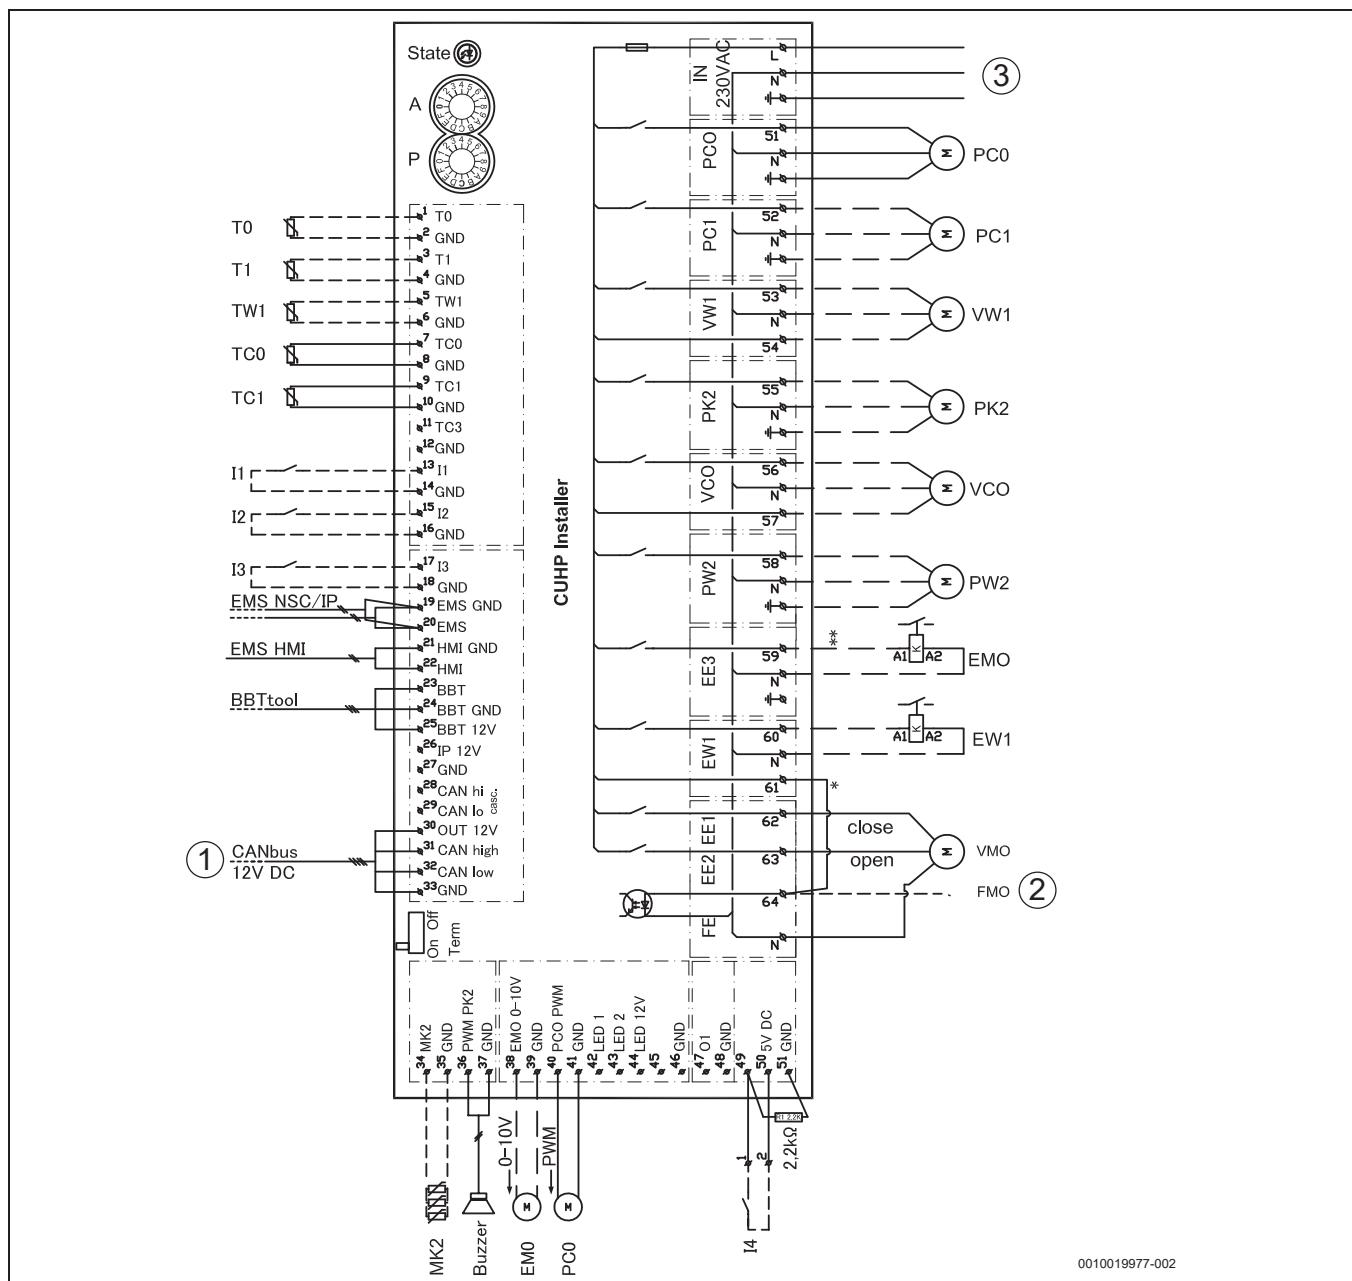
Schéma zapojení instalačního modulu s integrovaným elektrickým dotopem
